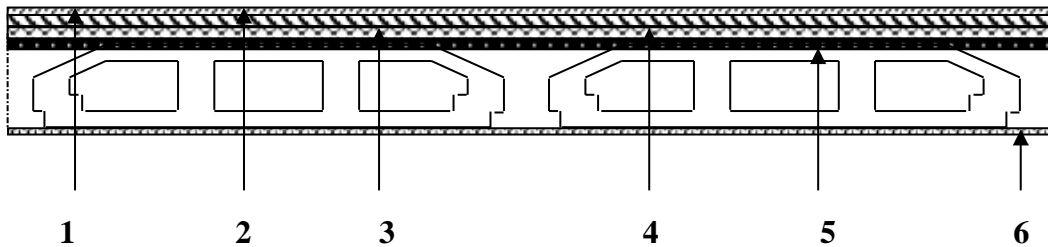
Coupe verticale du plancher terrasse a corps creux.
